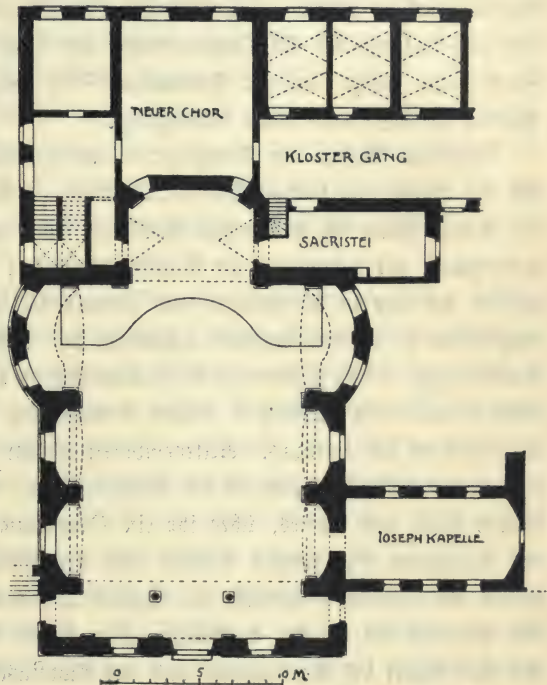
Altötting. Magdalenenkirche. Grundriß.
